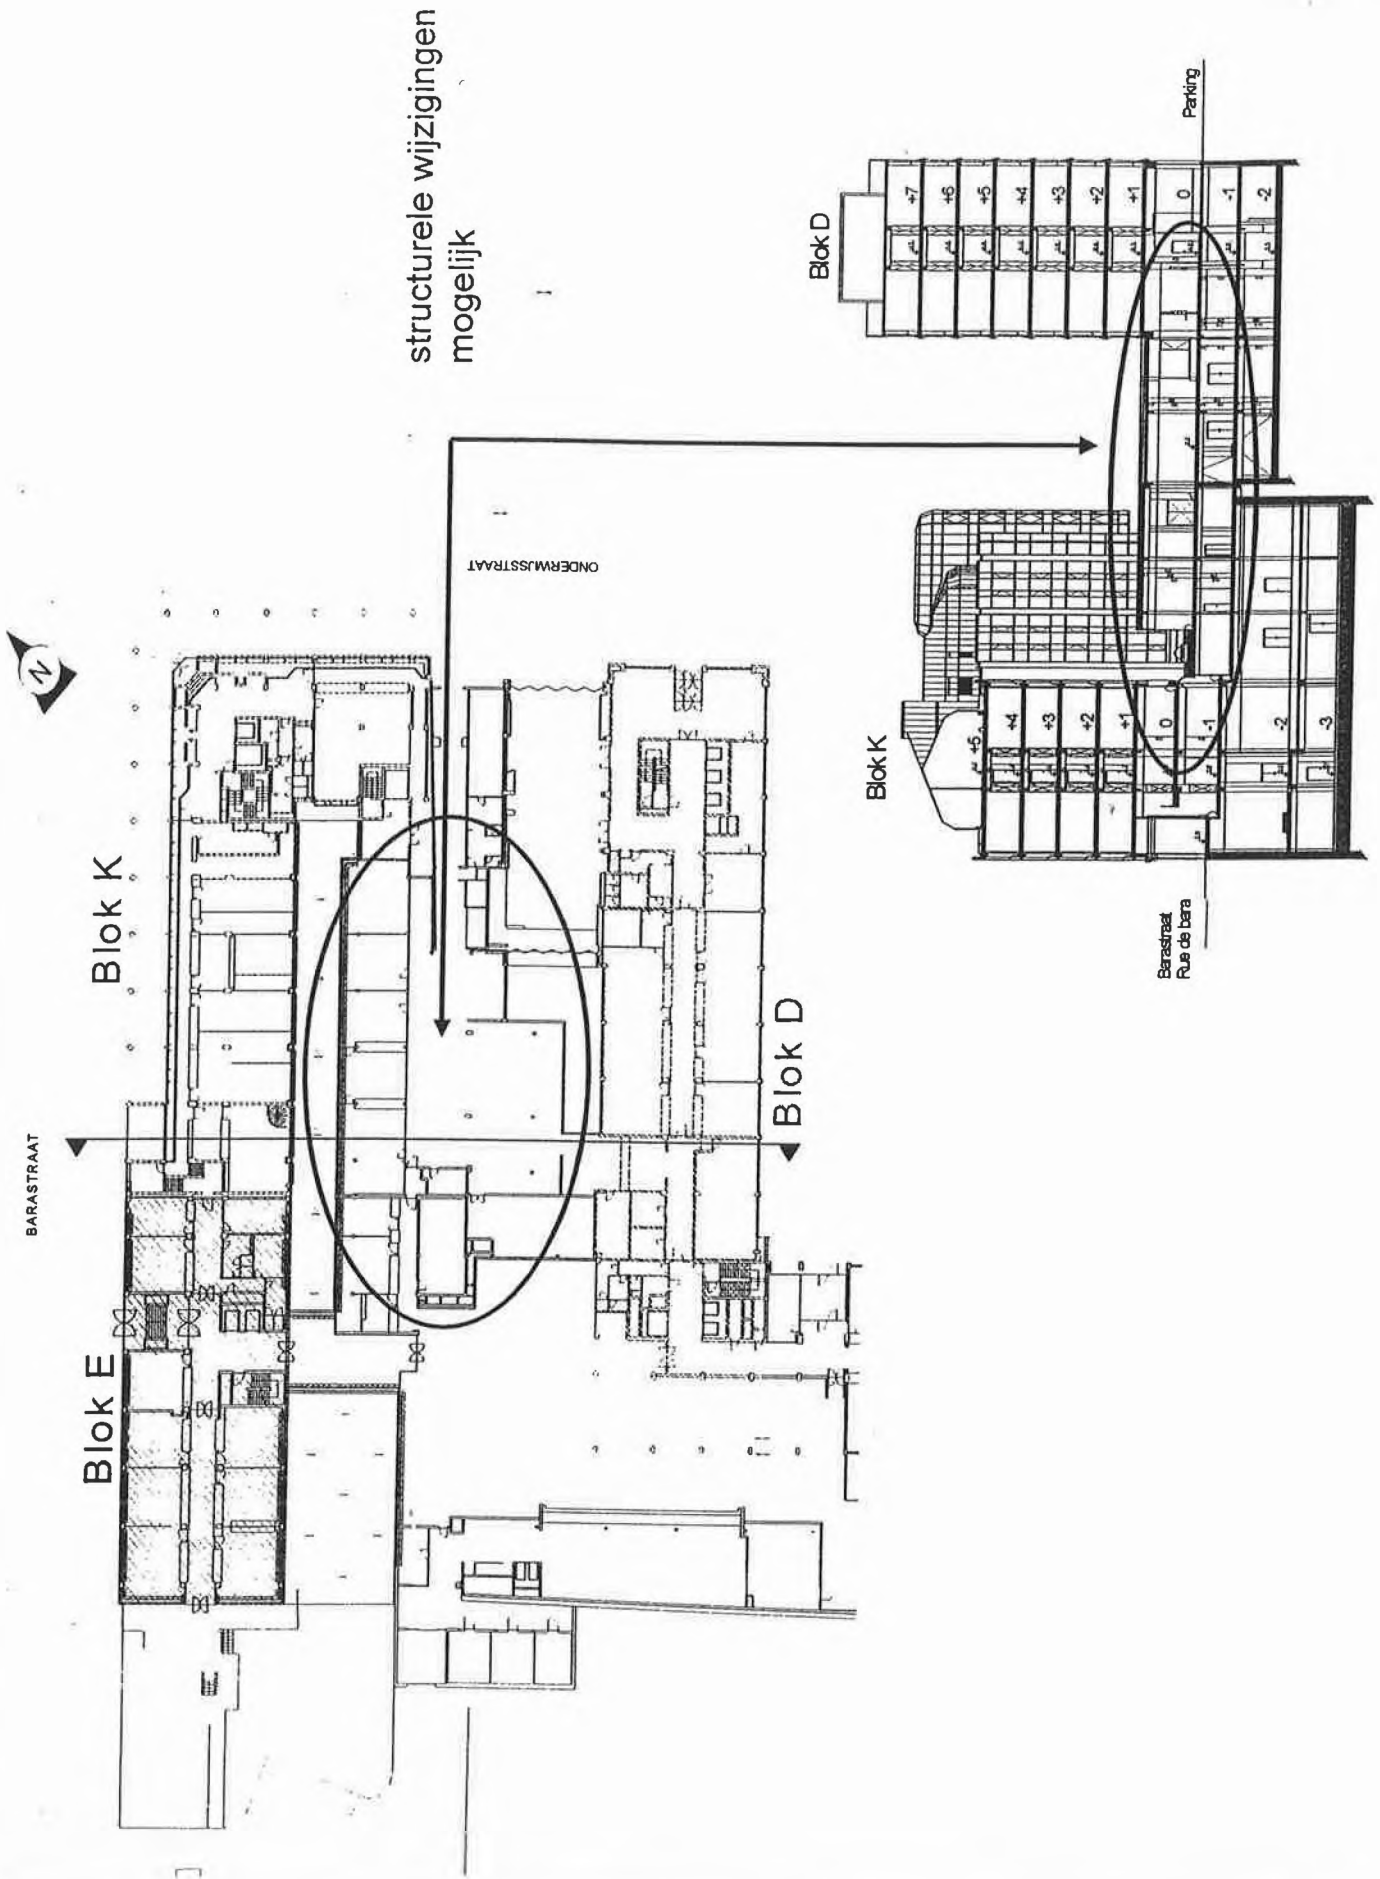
Grondplan gelijkvloers - Aanduiding van beschikbare zone
